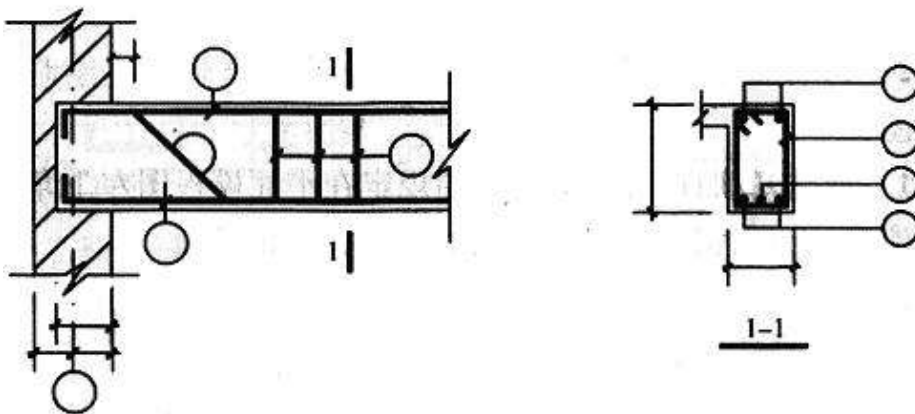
梁纵、横断面图中钢筋表示方法
